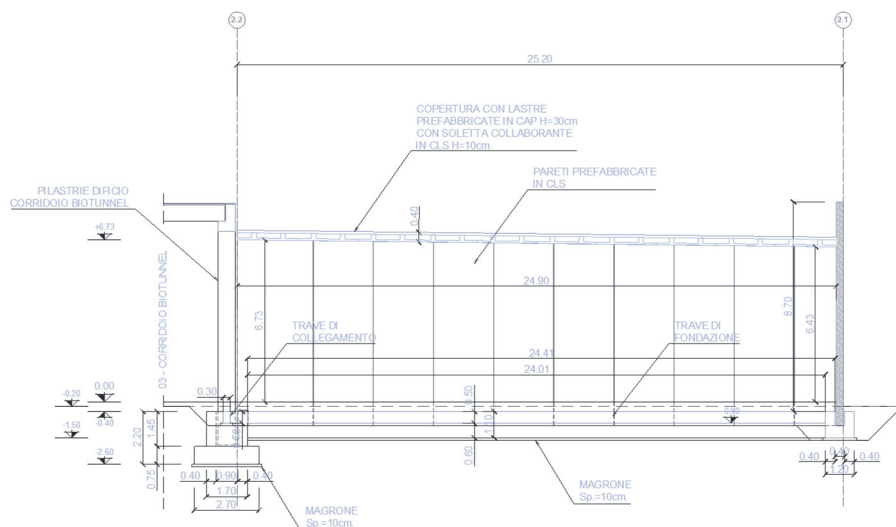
SEZIONE LONGITUDINALE BIOTUNNEL
